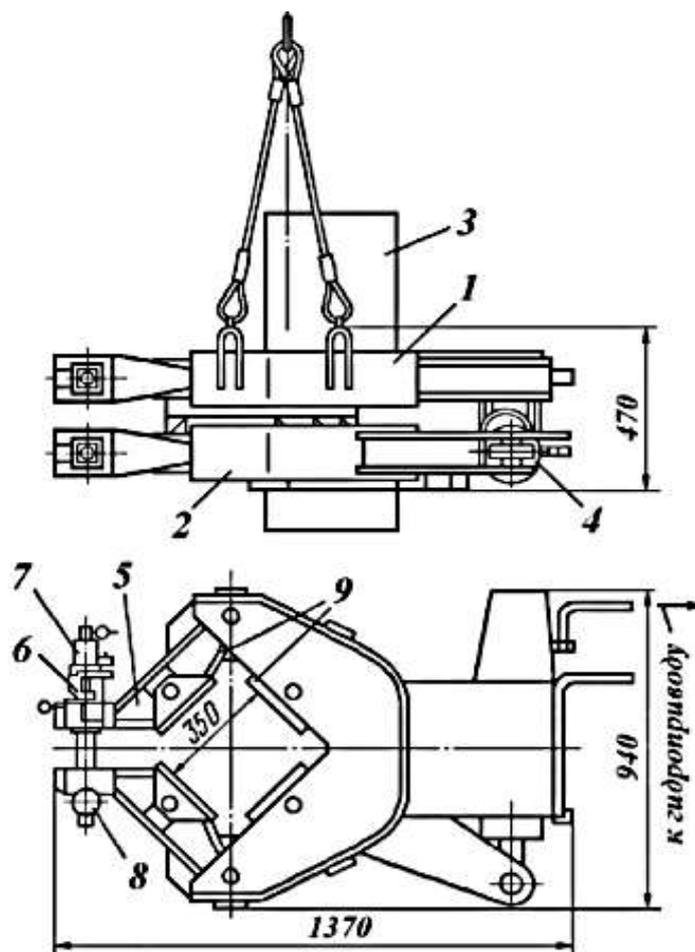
Схема устройства для скручивания железобетонных свай.
